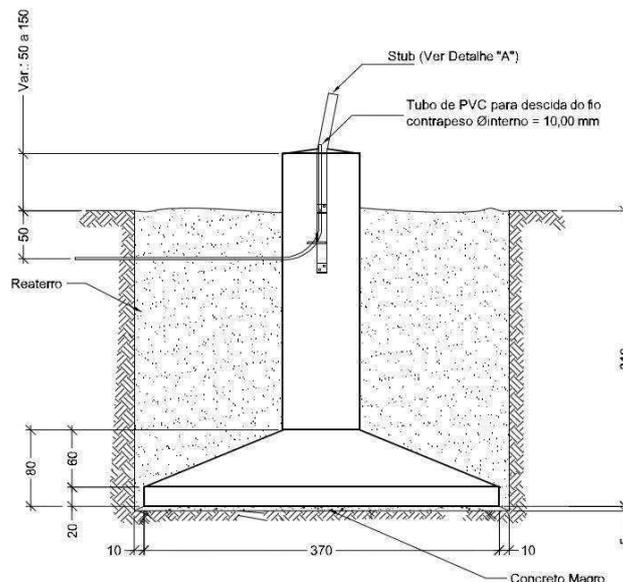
Detalhe da sapata para solo tipo A de estrutura metálica autoportante AF2d (Chesf, 2009).
